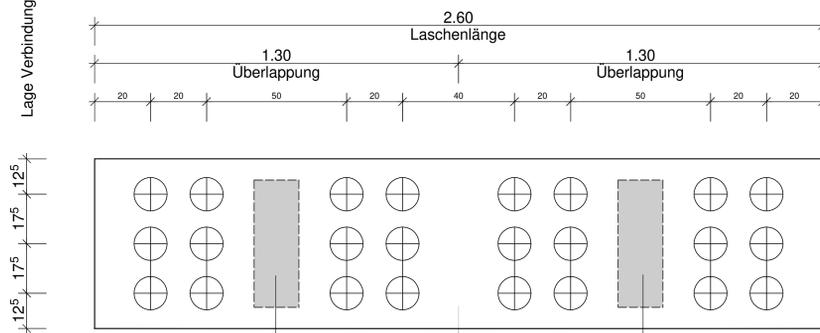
Anschluss Koppelstäbe - Querschnitt:
